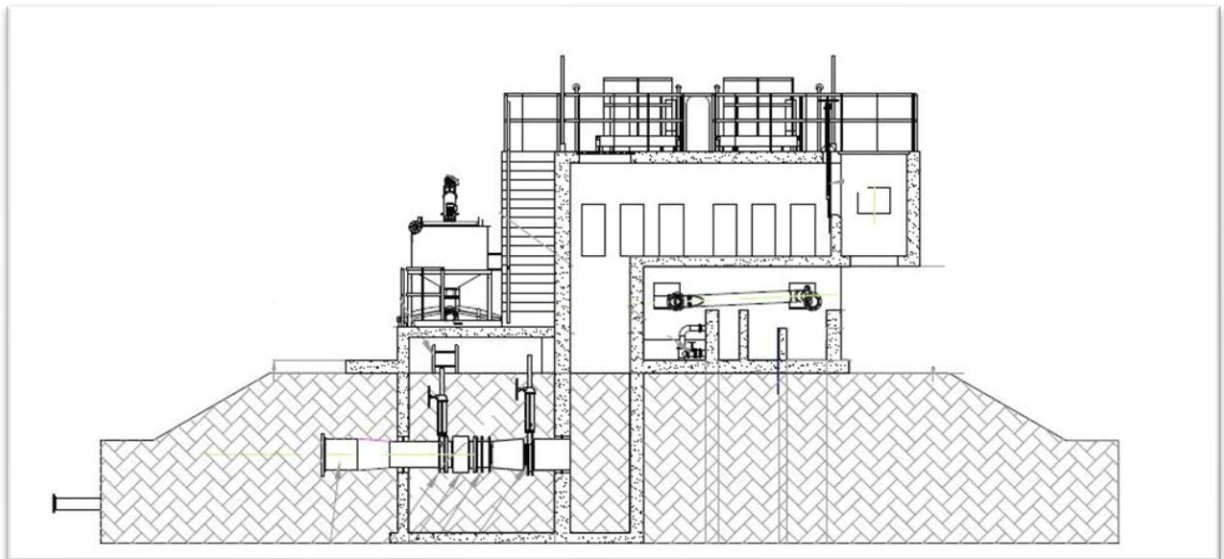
Vista en corte transversal del sector desarenador y desengrasador.
